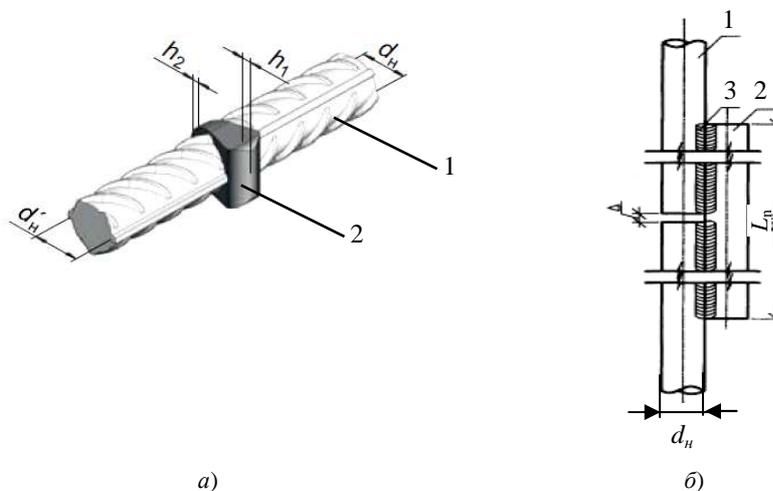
Конструктивное решение стыка стержней продольной арматуры колонны с применением ванной сварки:
